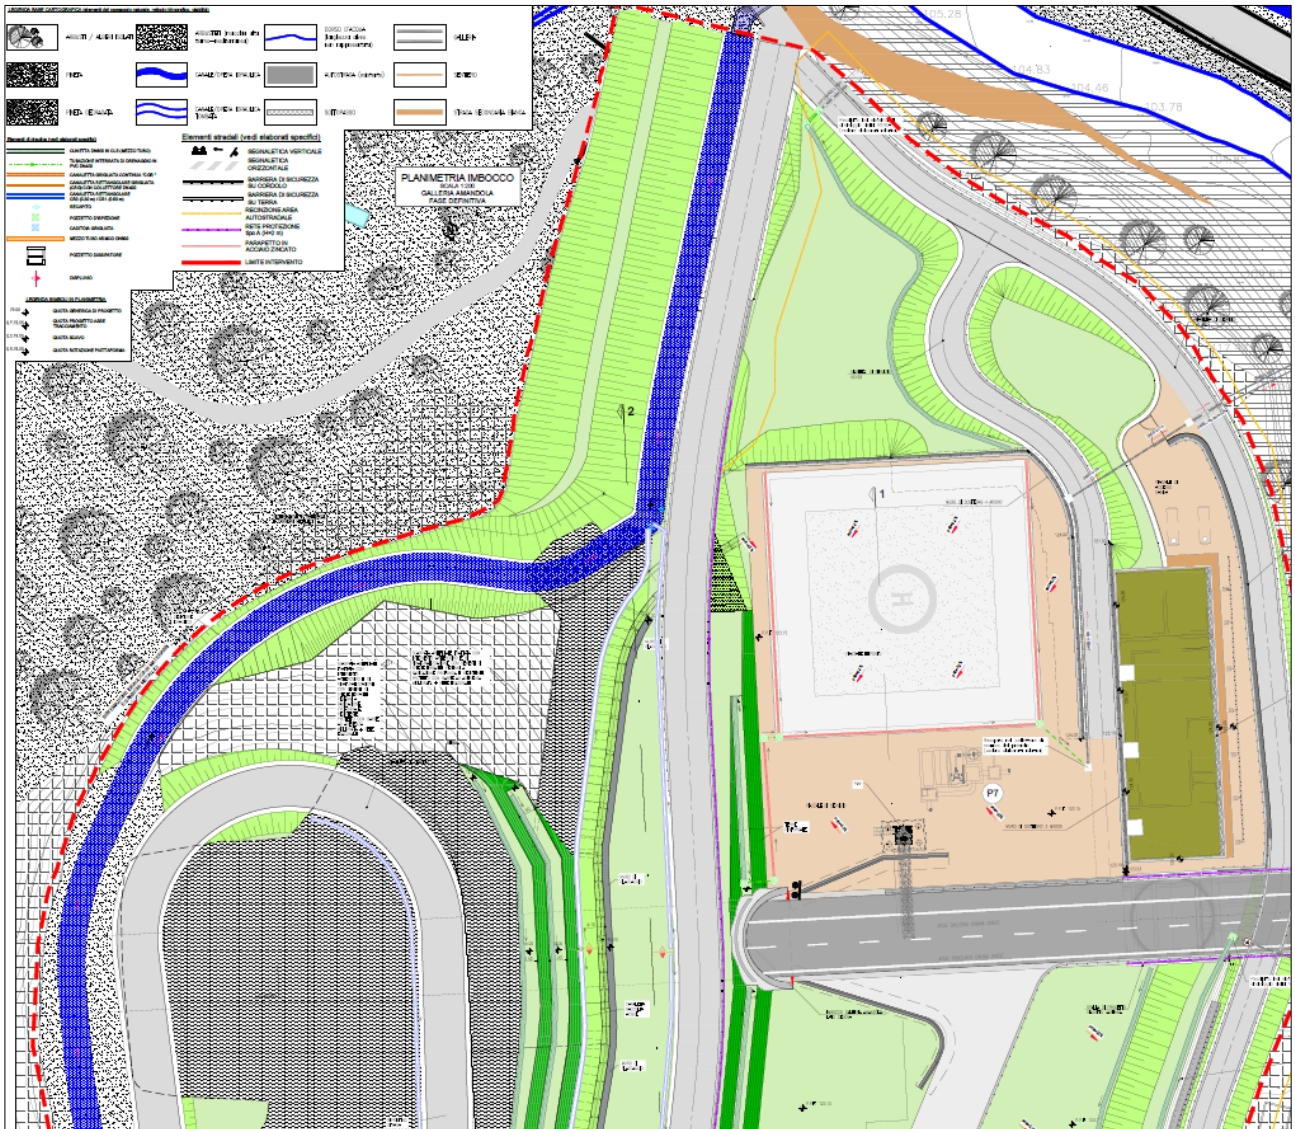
Planimetria stato finale area di imbocco 1/2 (fonte: elaborato 110728-LL8C-PE-A1-G06-GF06E-SSF00-D-AUA1995-1)
